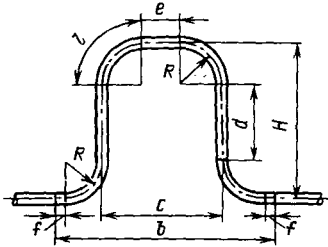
Схема типоразмеров П-образных компенсаторов с гнутыми отводами
